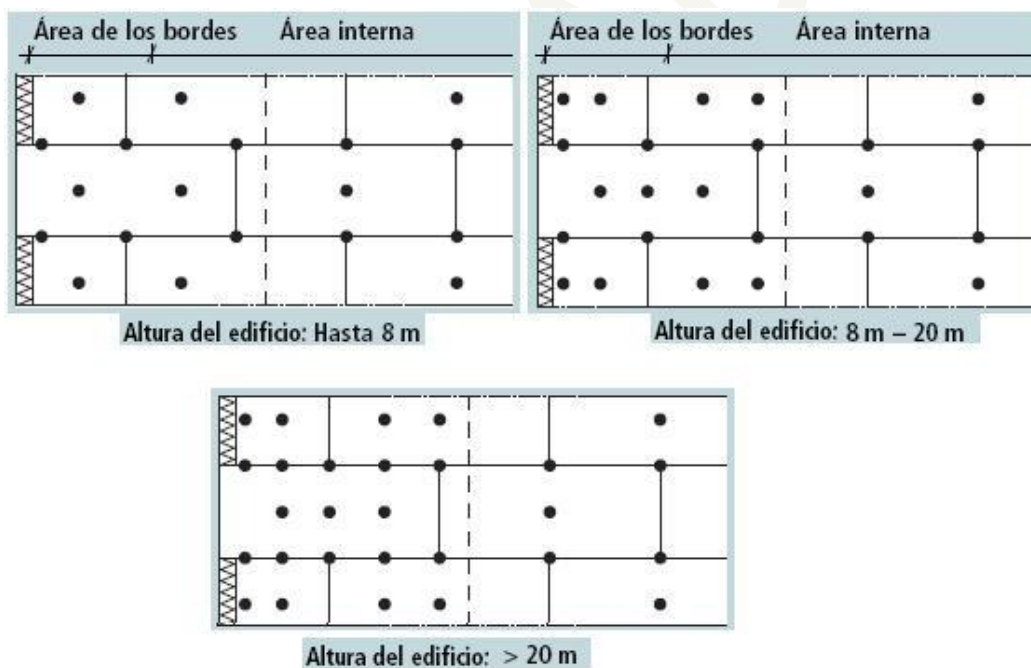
Esquema de colocación de espigas en las aristas del edificio.
